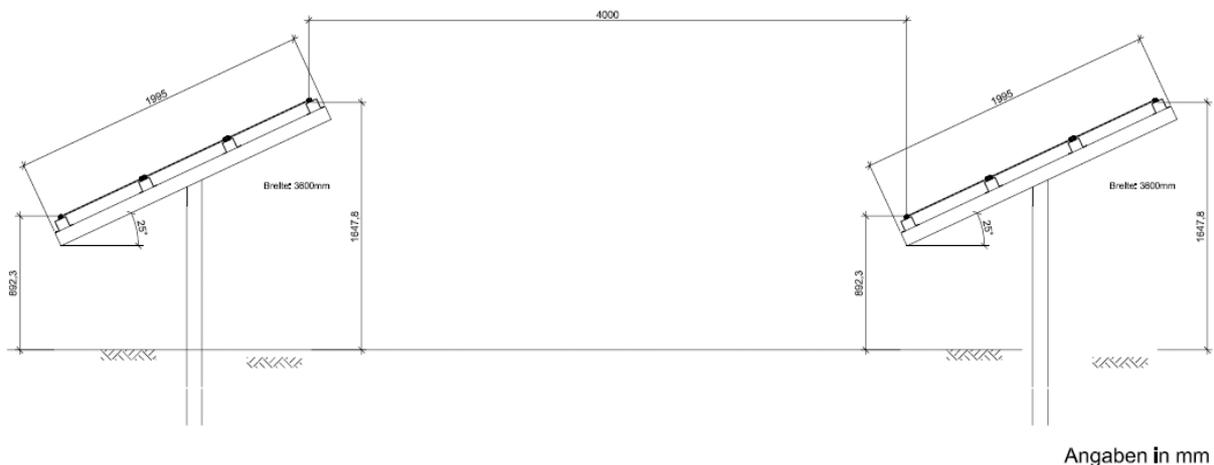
Schemaschnitt für den Standort Esch (Pfahlgründung)
